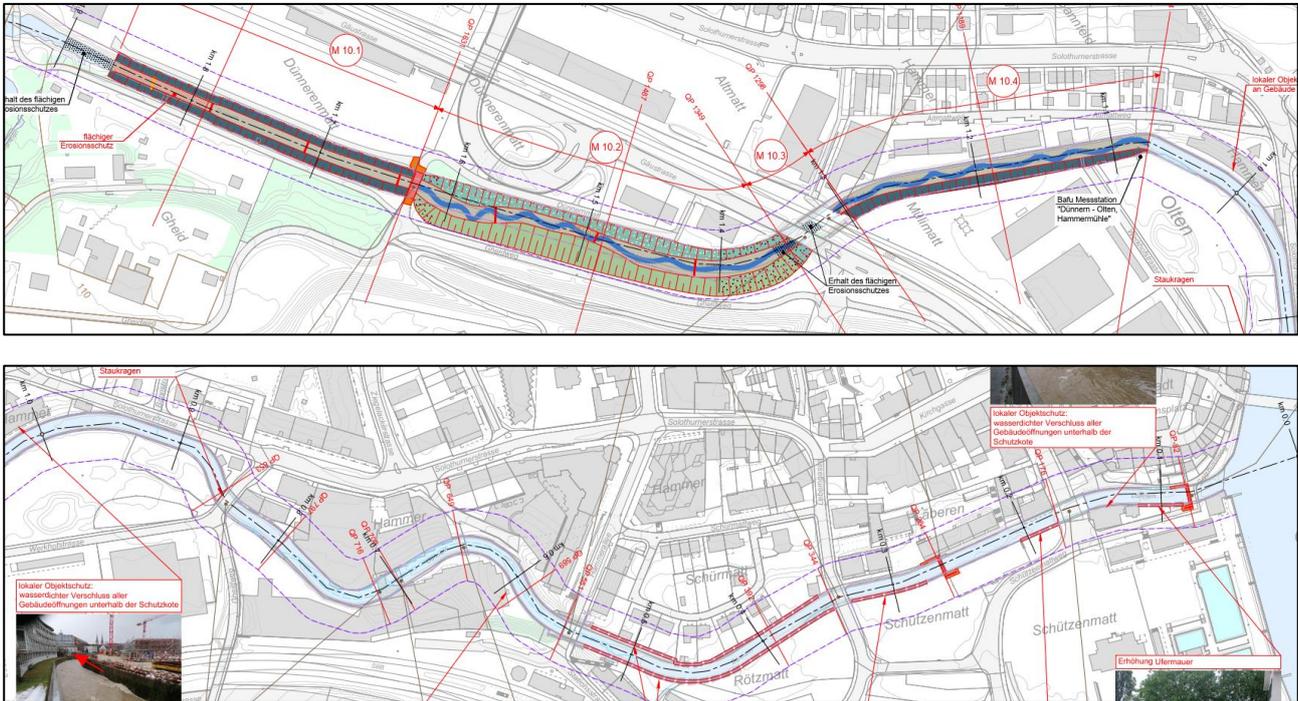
Ausschnitt Situationsplan (oben: Abschnitt 10-1, unten: Abschnitt 10-2).
